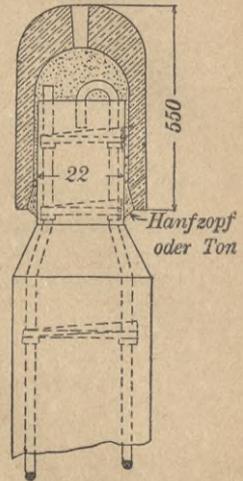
Eiserner Rammhaube für Eisenbetonpfähle.
